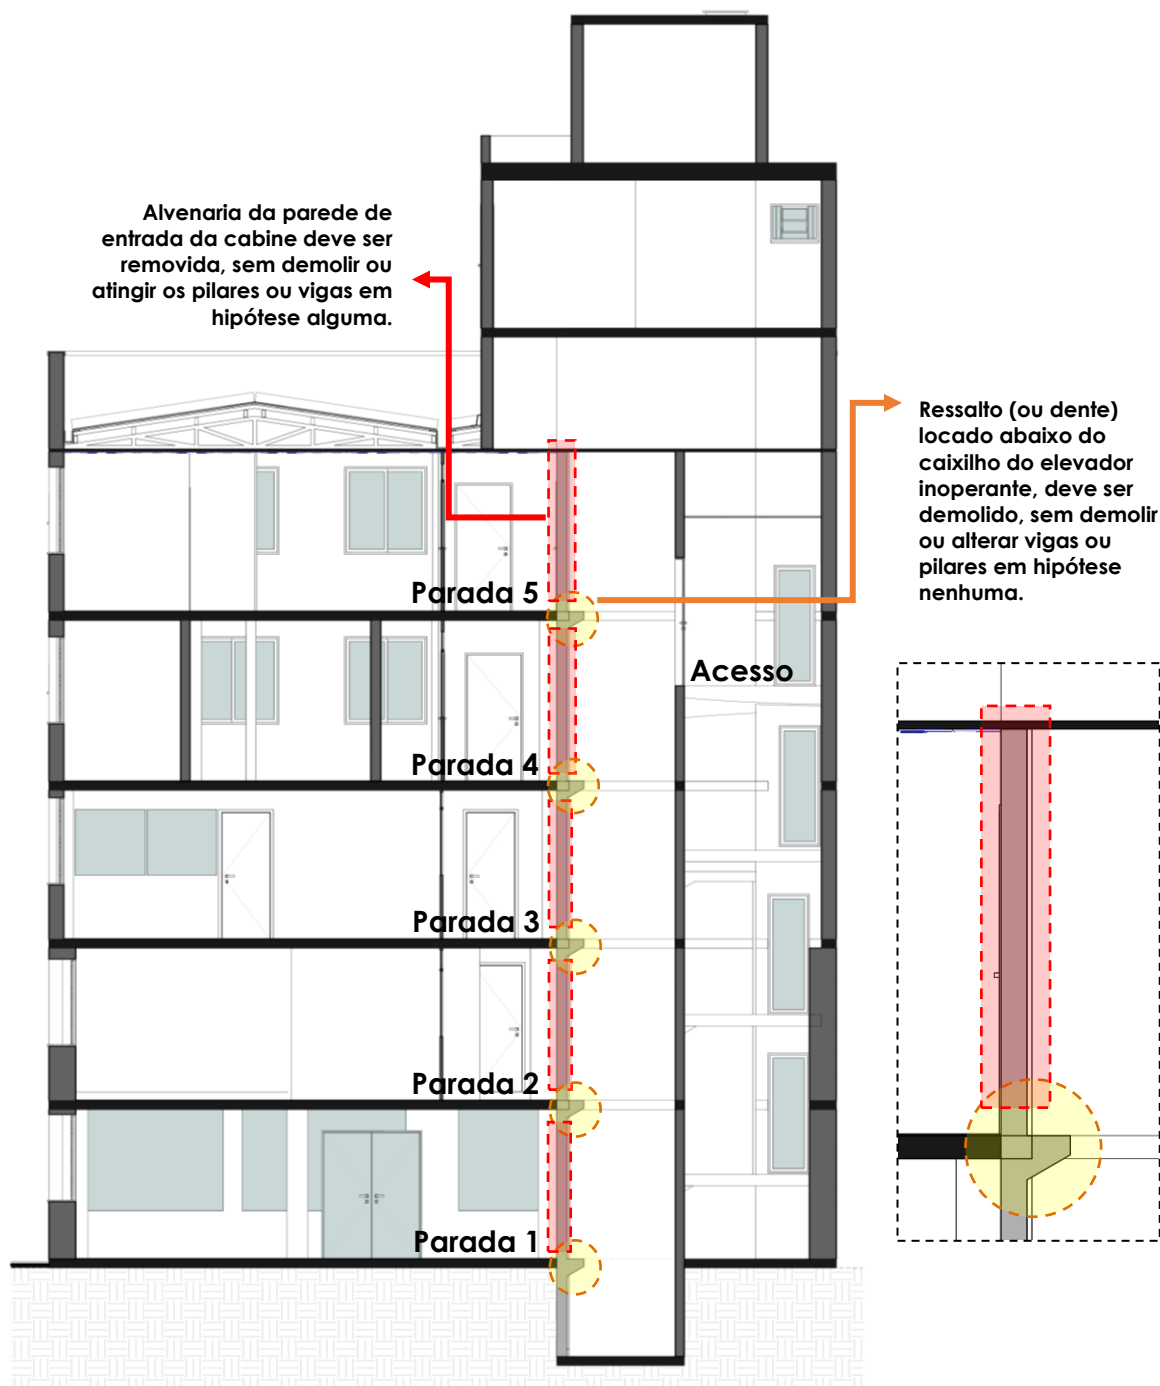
Corte com indicação de intervenções em ressalto abaixo do caixilho do elevador a ser desinstalado, e na alvenaria na parede de entrada (Triplan Engenharia, 2023)
